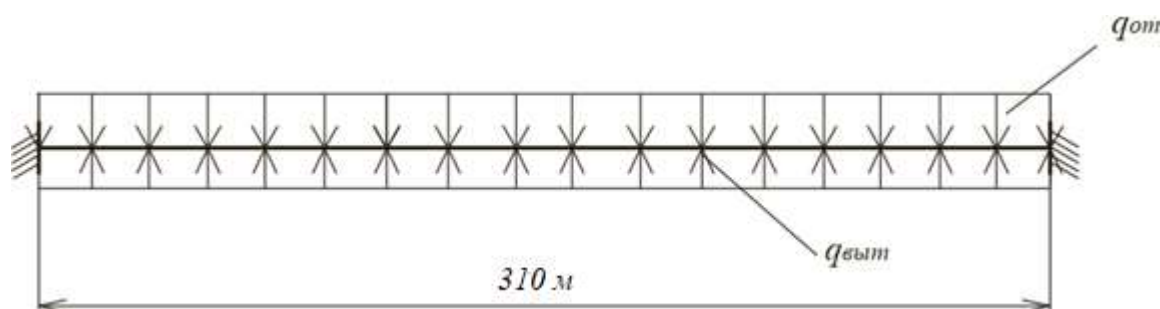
Расчетная схема трубопровода со сплошным обетонированием
